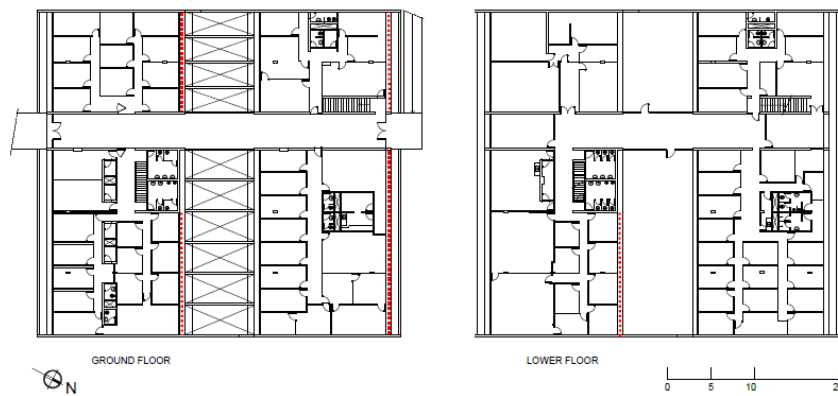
Planta baixa FE3 pavimento Térreo e Inferior. Fonte: Prefeitura do *campus* (adaptado por Christine Lucas).
